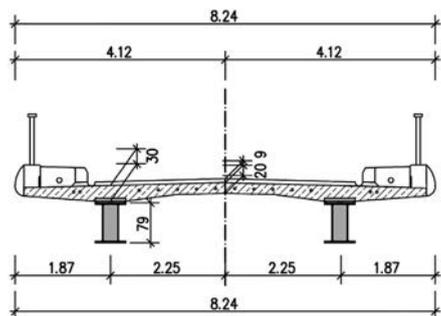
Querschnitt mit Betonsegmenten [9], [10]
